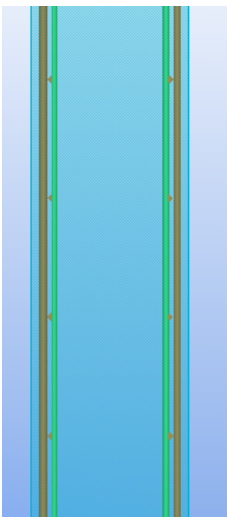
Rectangular spandrel – automated rectangular reinforcement layout (56)* –kuvake
